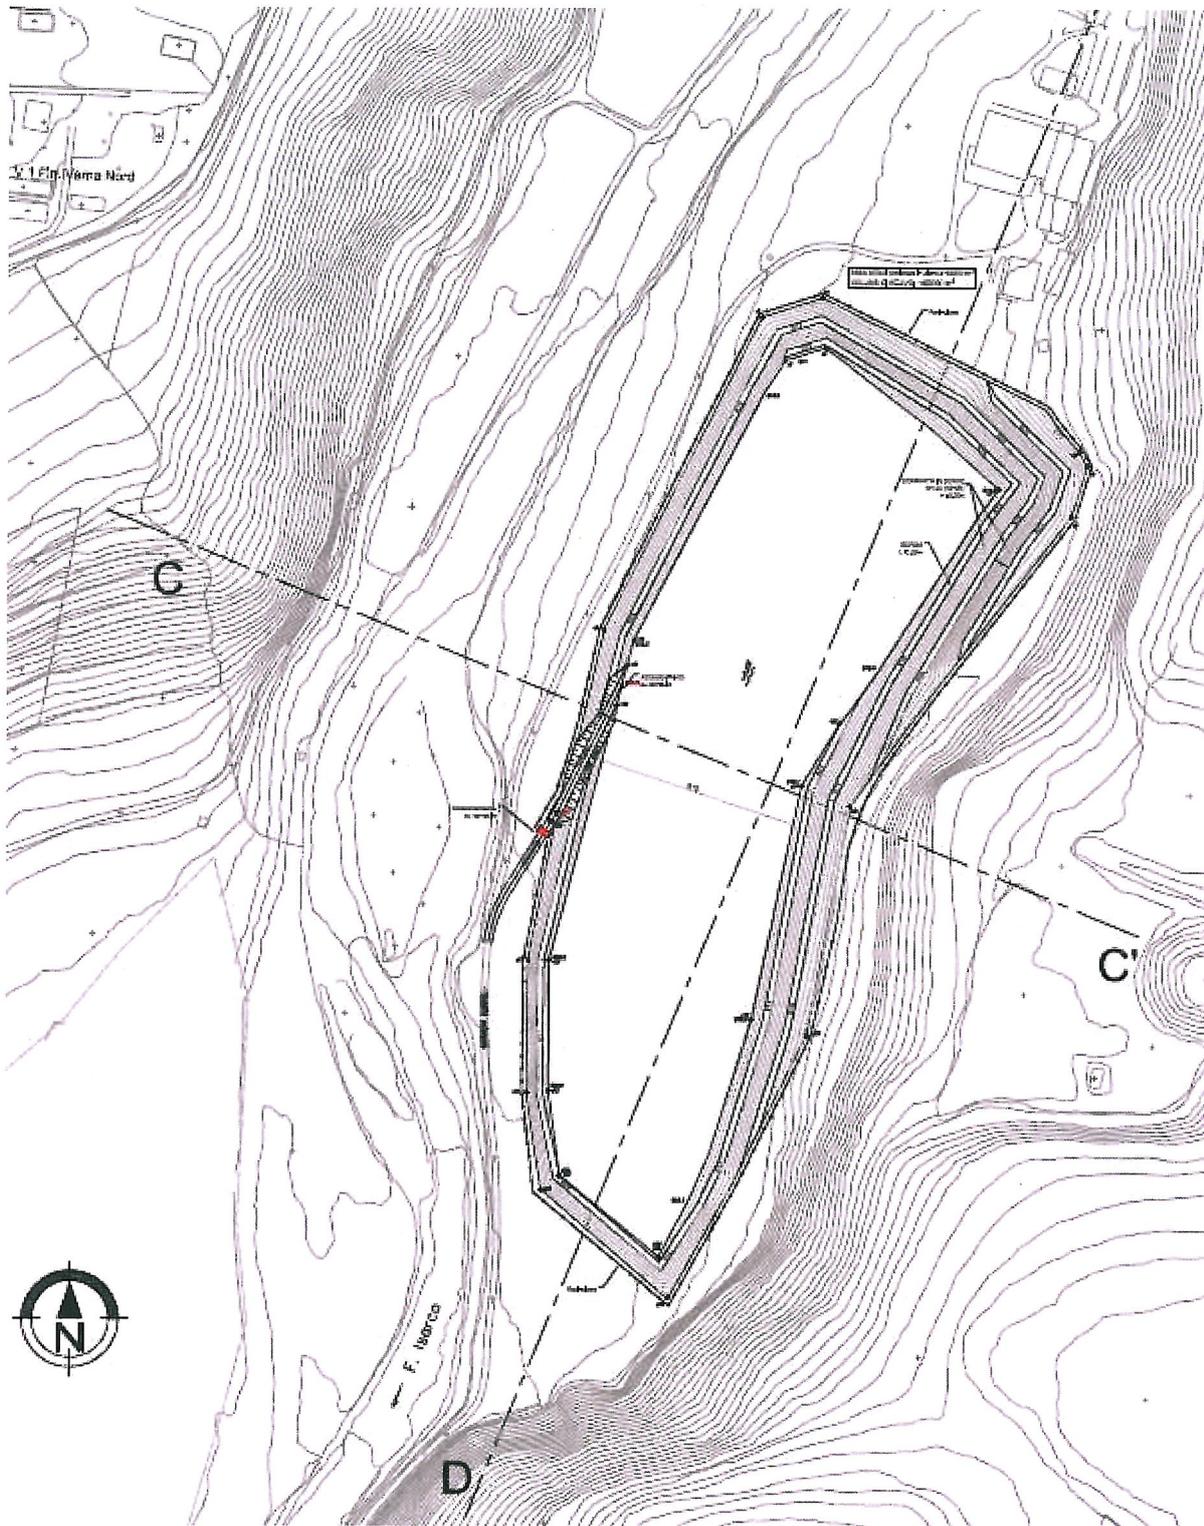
Depositi definitivi in Val Riga – B – Plaikner – Pianta scavi
